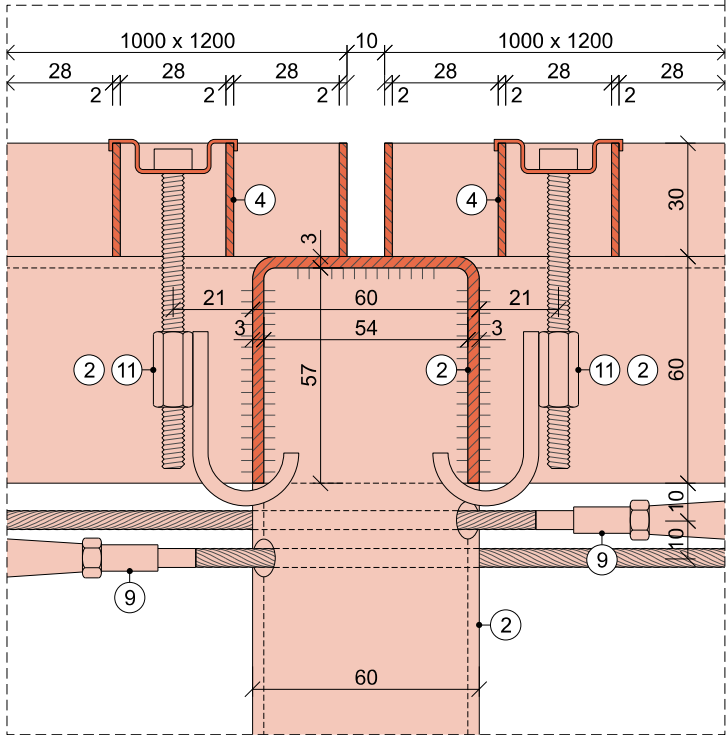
REKTIKAFKÁ NOHA S PÁTKOU (PÔDORYS)
